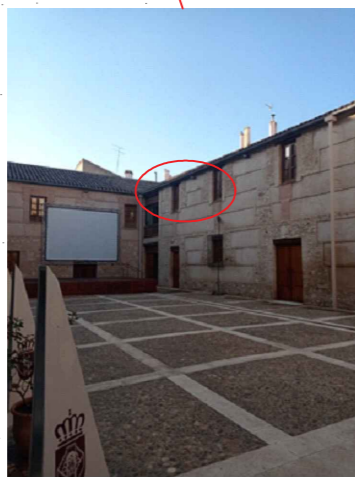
EQUIPOS 1. CUBIERTA POSTERIOR
